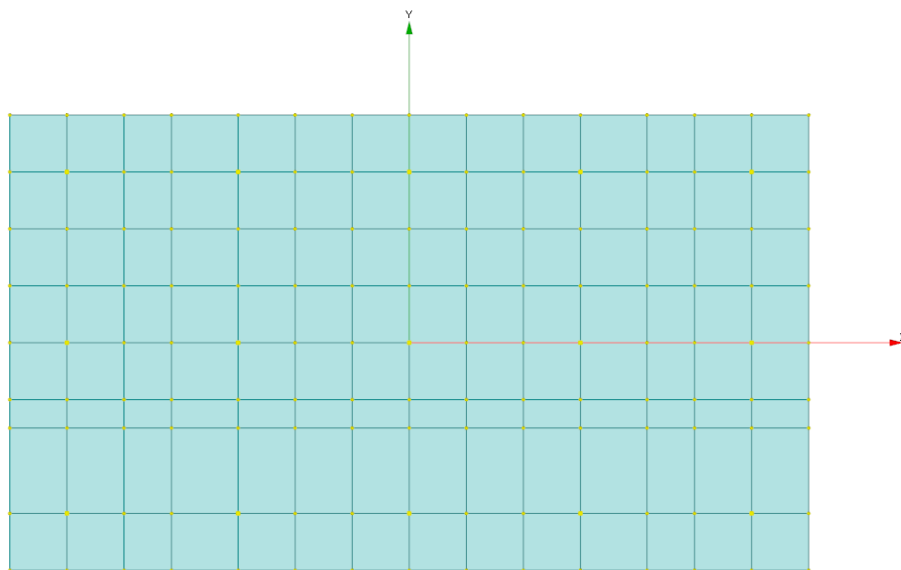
VISTA PLANIMETRICA SPALLA 1 - ASSI DI RIFERIMENTO
